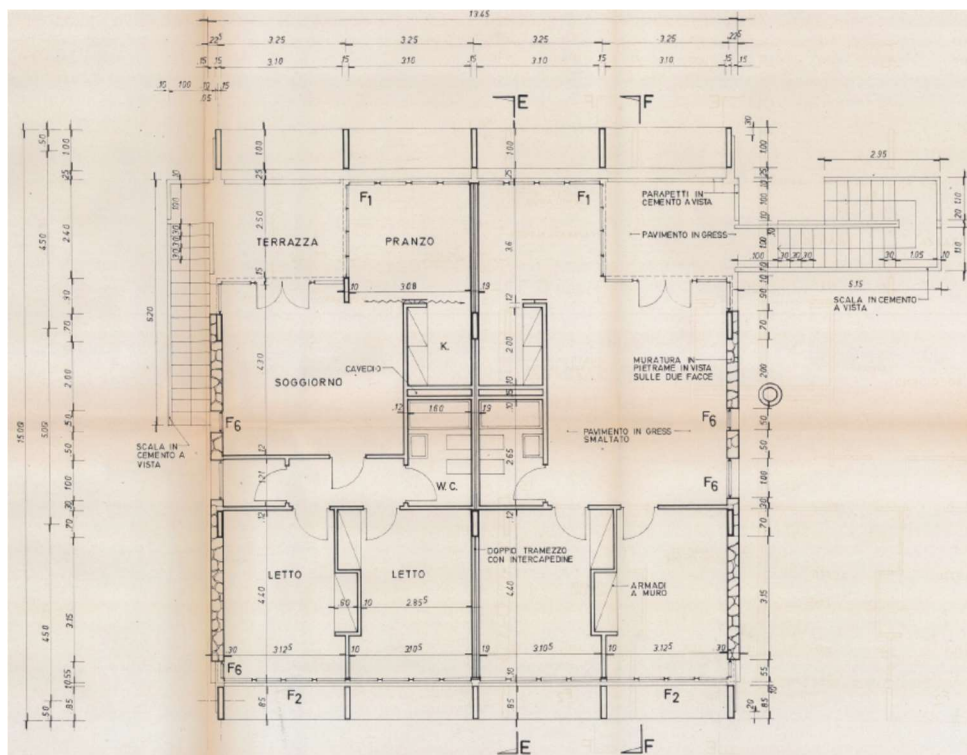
Progetto di fattibilità del 1972 – Pianta primo piano
